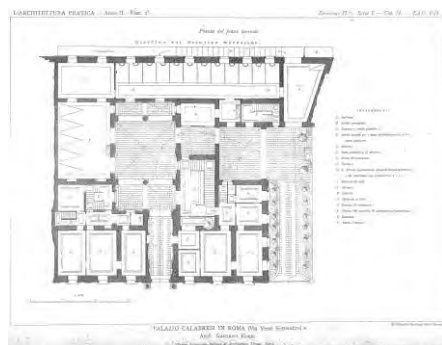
pianta piano terra da “L'Architettura pratica”, 1881
